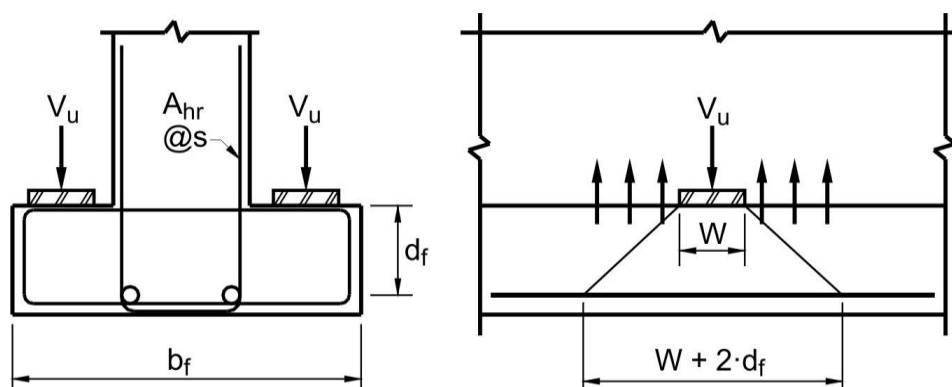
Armadura de suspensión en una viga T invertida
